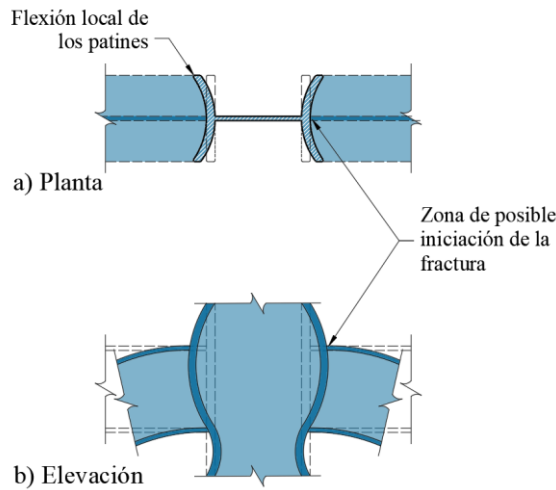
Deformación de una columna sin atiesadores
